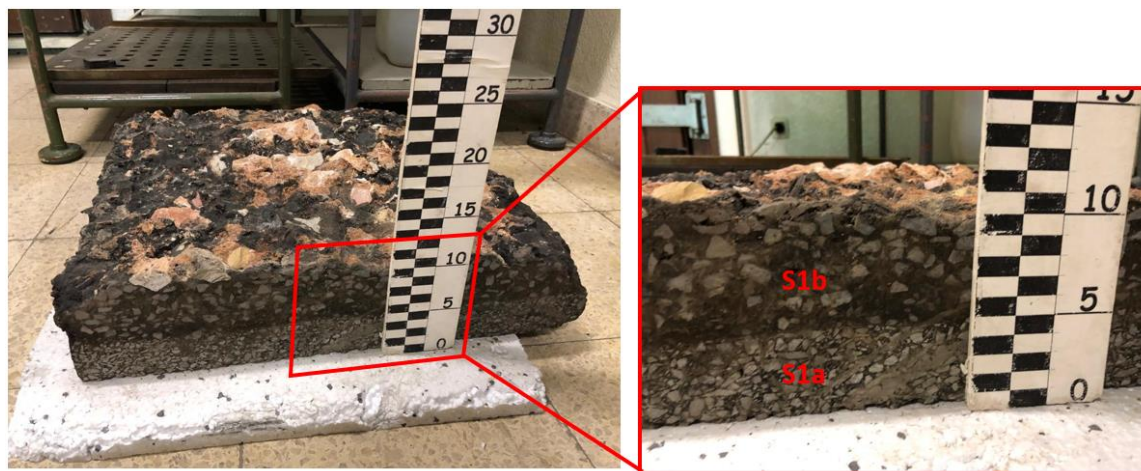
Laje retirada do pavimento ensaiado após o reforço.
